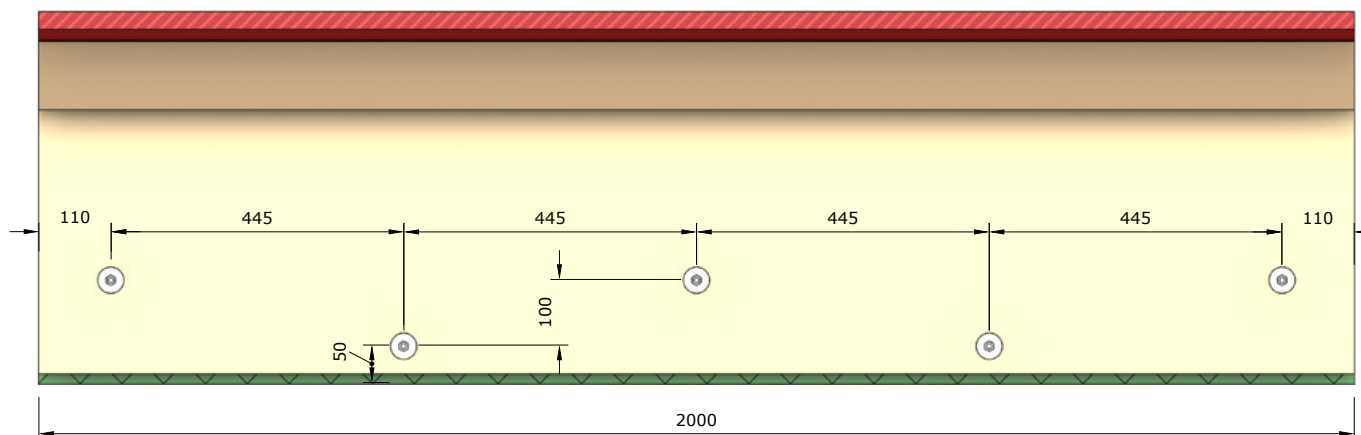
Vue arrière des types d'acrotères 4.1 et 4.2, dimensions des boulons d'ancrage en mm.
